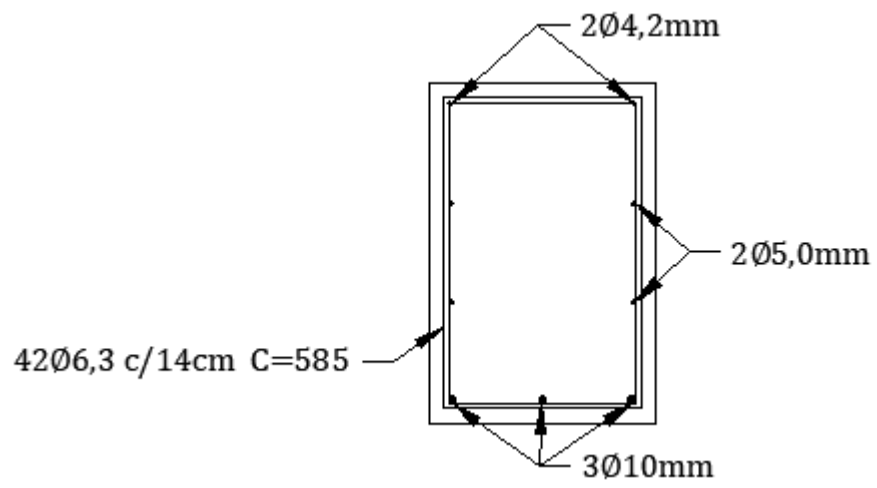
Detalhamento da viga lateral inclinada (Fonte: autor).
